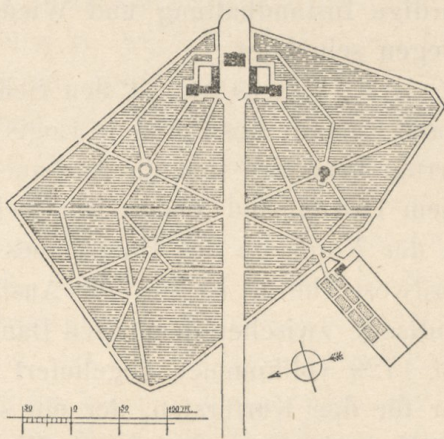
Falkenlust, Situationsplan nach dem im Besitz der kgl. Regierung zu Köln befindlichen Plan v. 1735—48.
